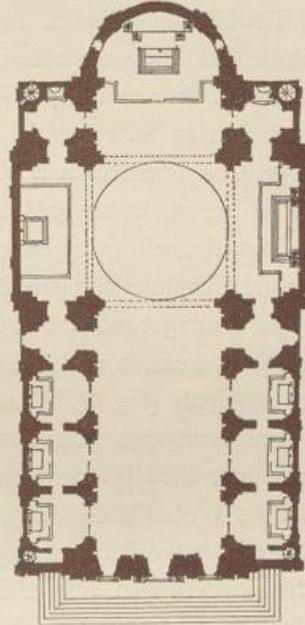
Grundriss der Kirche del Gesù in Rom.
